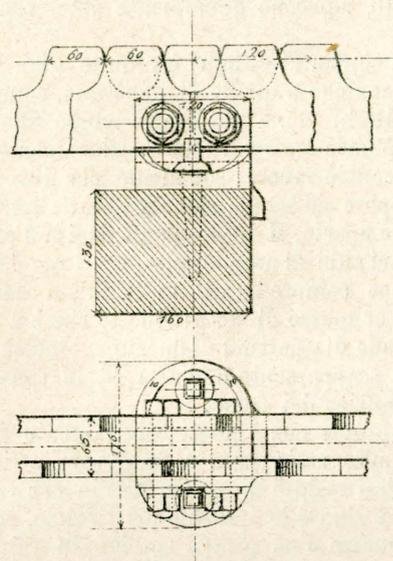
Id. id., elevazione e pianta. Scala di 1 : 8.
